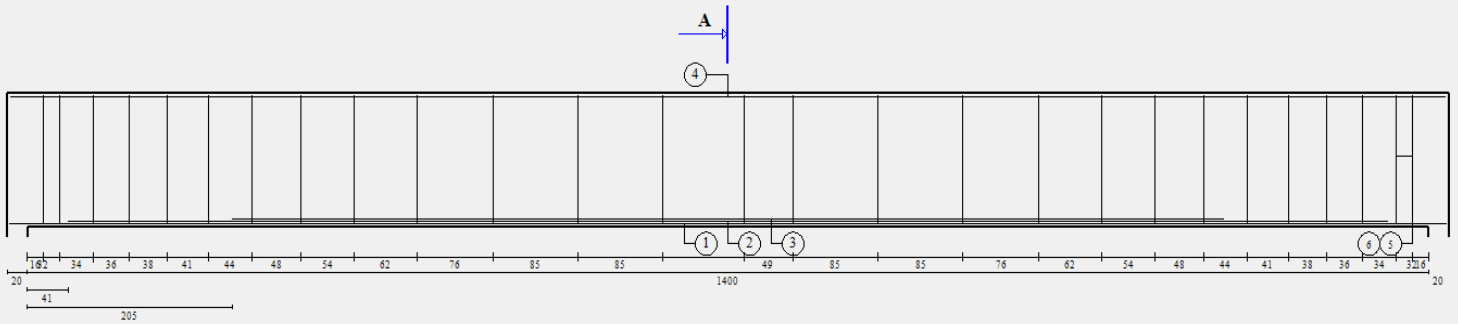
Ecran plan de ferrailage - armatures hautes
